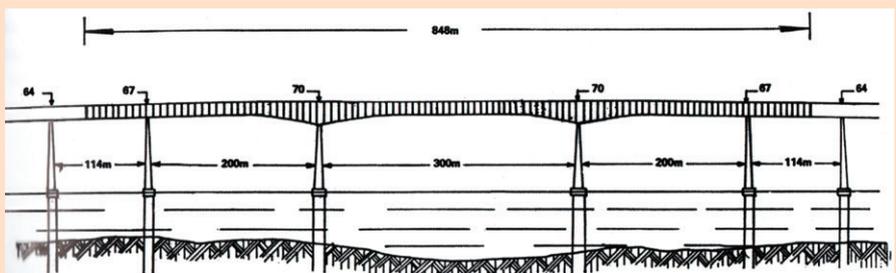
ESQUEMA DE ESTRUTURA METÁLICA [23]
